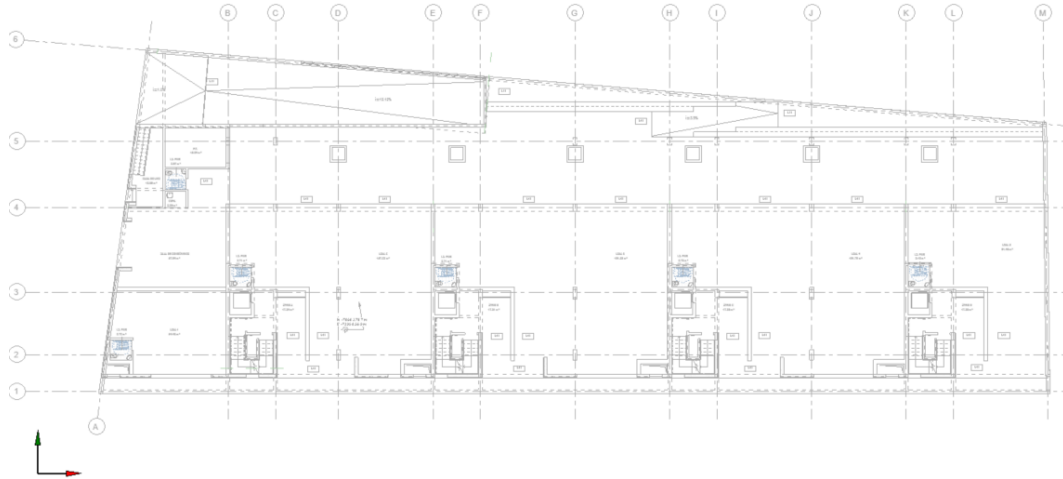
Visualização da planta do piso 0 de arquitetura após o comando *Half tone*.
